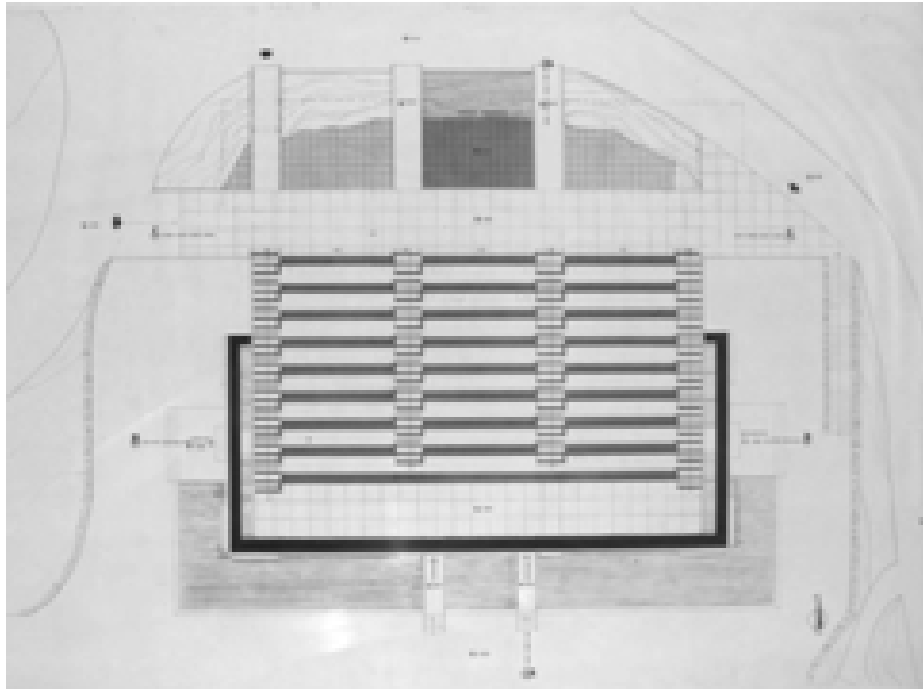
Planimetria dello stato sovrapposto, progetto concessionato il 15/01/1985 (AABS-916)
